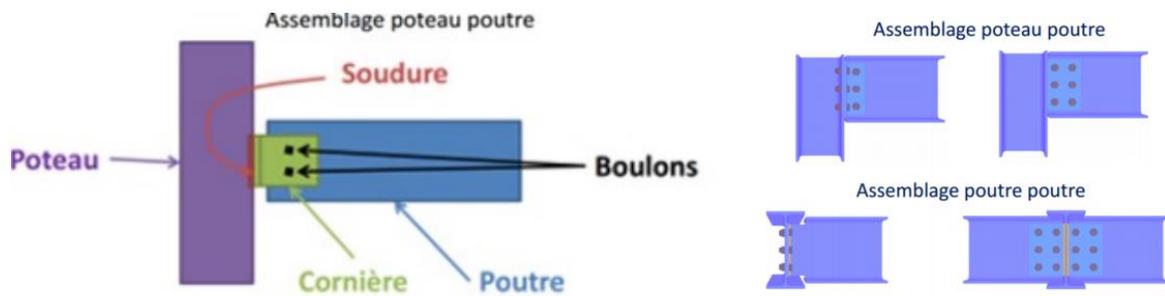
Principe des assemblages entre le poteau et la poutre. (Source : slide-Share de structure métallique)
